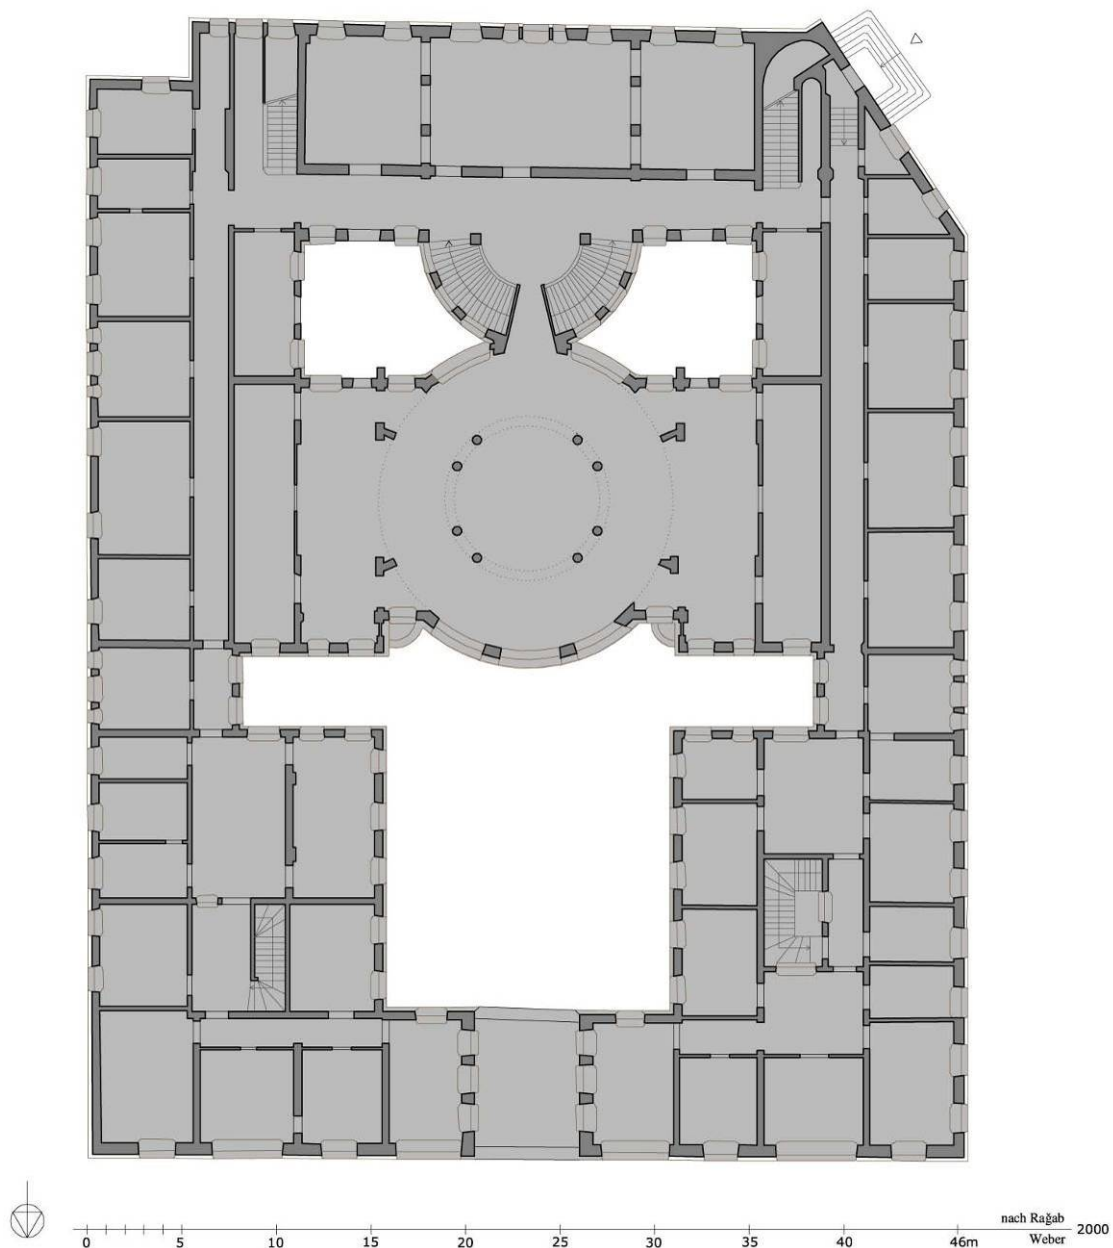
Handelsgebäude al-Ābid, Grundriss 1. OG
